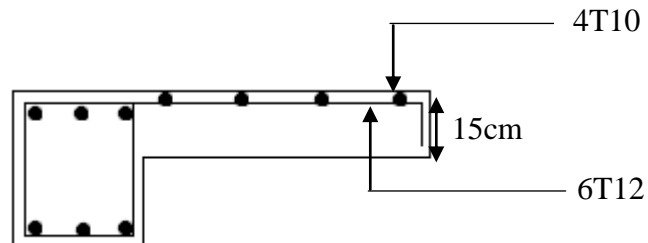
b : Schéma de ferrailage du porte à faux (terrasse)
